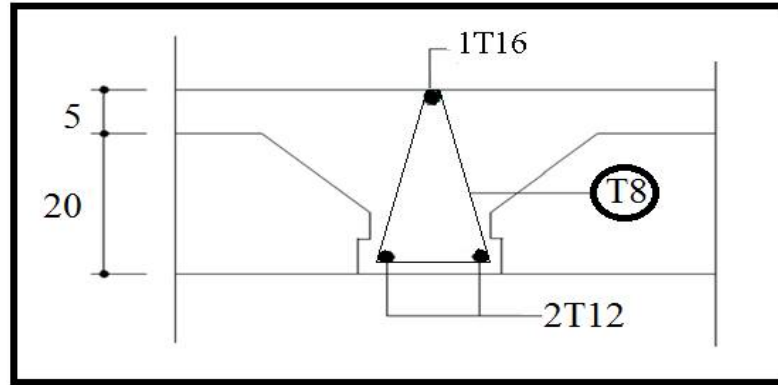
Schéma de ferrailage de la poutrelle étage courant.
